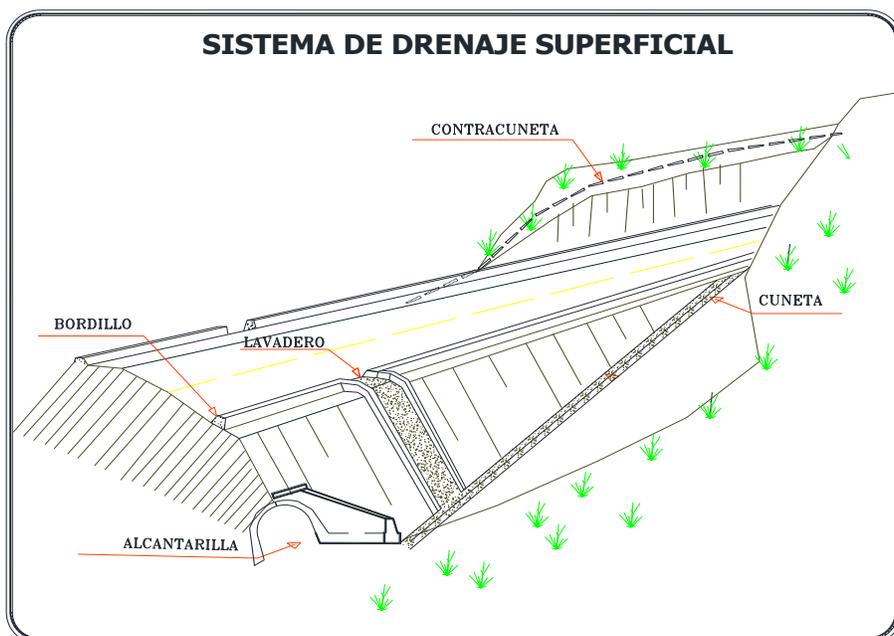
ELEMENTOS DE DRENAJE SUPERFICIAL EN CARRETERAS
